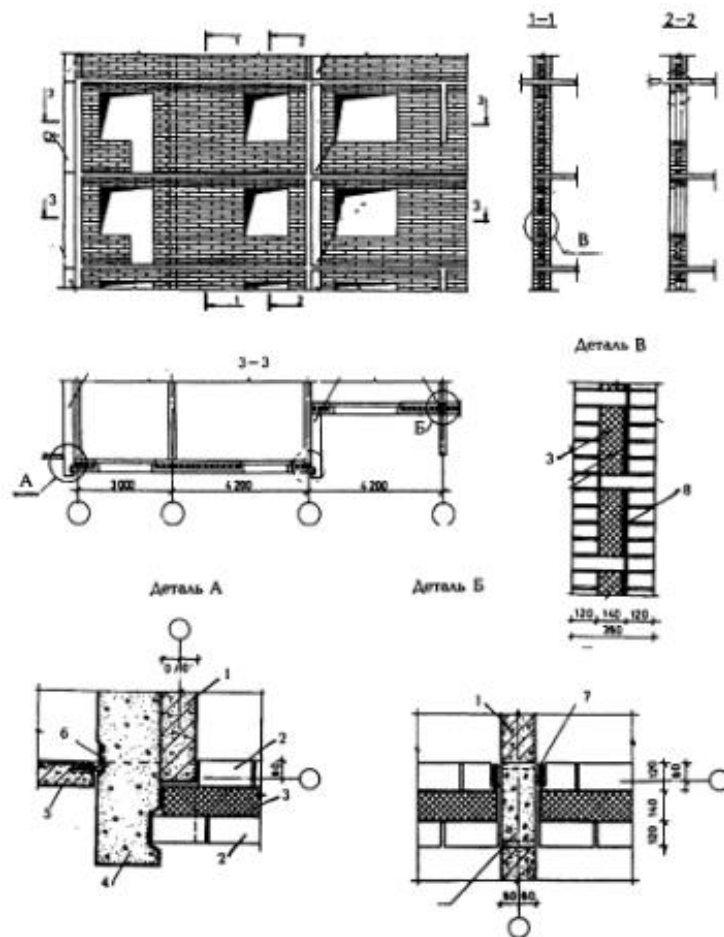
Кирпичная наружная стена монолитного здания (фрагмент фасада и конструктивные узлы): 1 - внутренняя стена; 2 - кирпичная наружная стена облегченной трехслойной конструкции; 3 - эффективный утеплитель; 4 - легкобетонная панель утепления торцевой стены; 5 - плиты ограждения лоджии; 6 - стальная связевая накладка; 7 - конопатка; 8 - пароизоляционный слой
